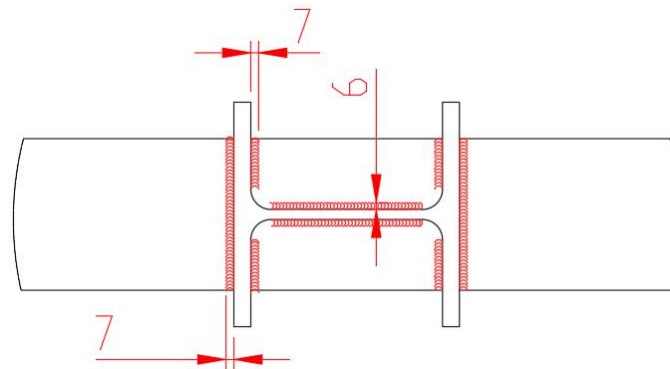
Unión de apoyo viga IPE-270-pilar HEB-200.
